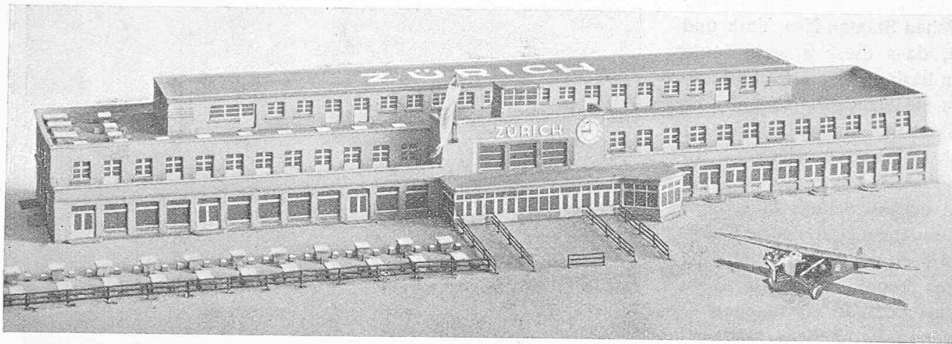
Modellbild des projektierten Stationsgebäudes (4 in untenstehendem Plan).
